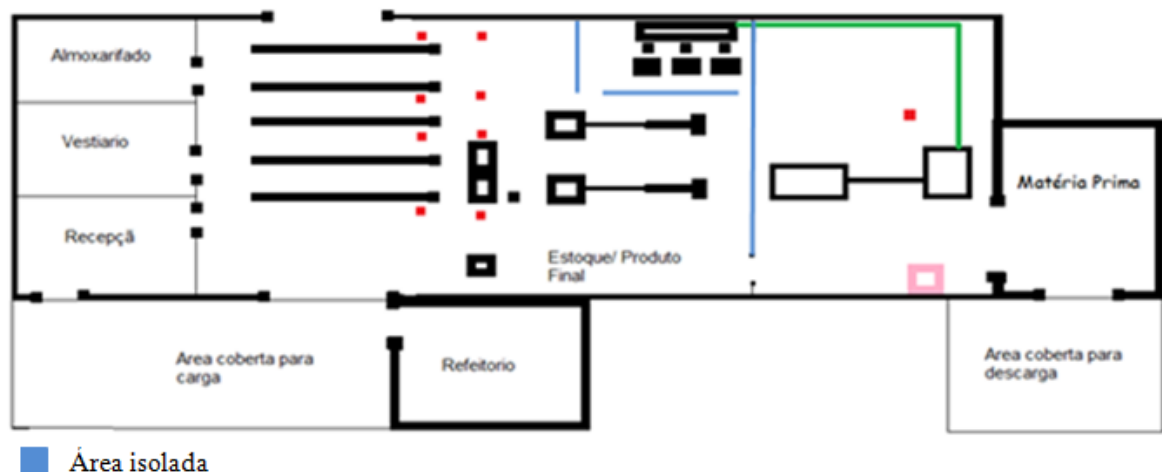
Planta baixa separando os pontos críticos – Indústria de Mangueiras
